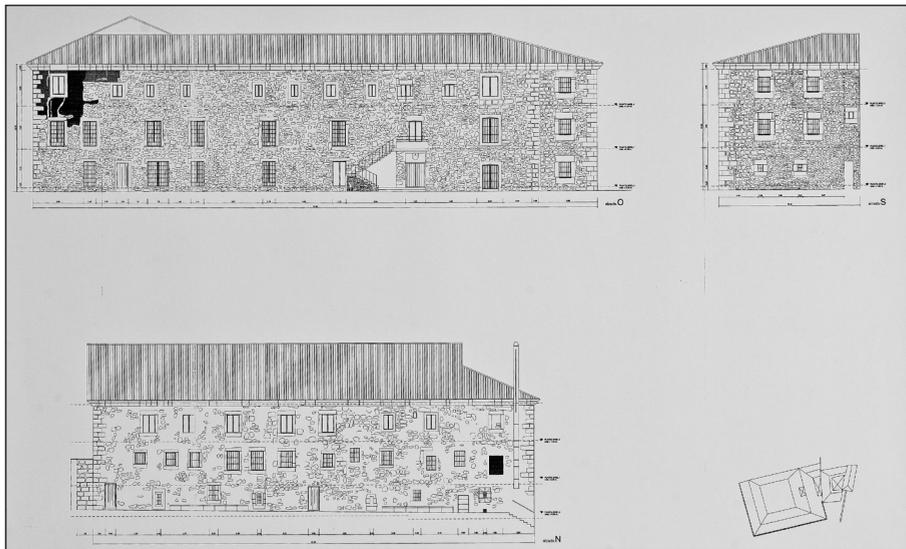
Alzados del hospital. Proyecto de restauración de fachadas. I. Picazo.
